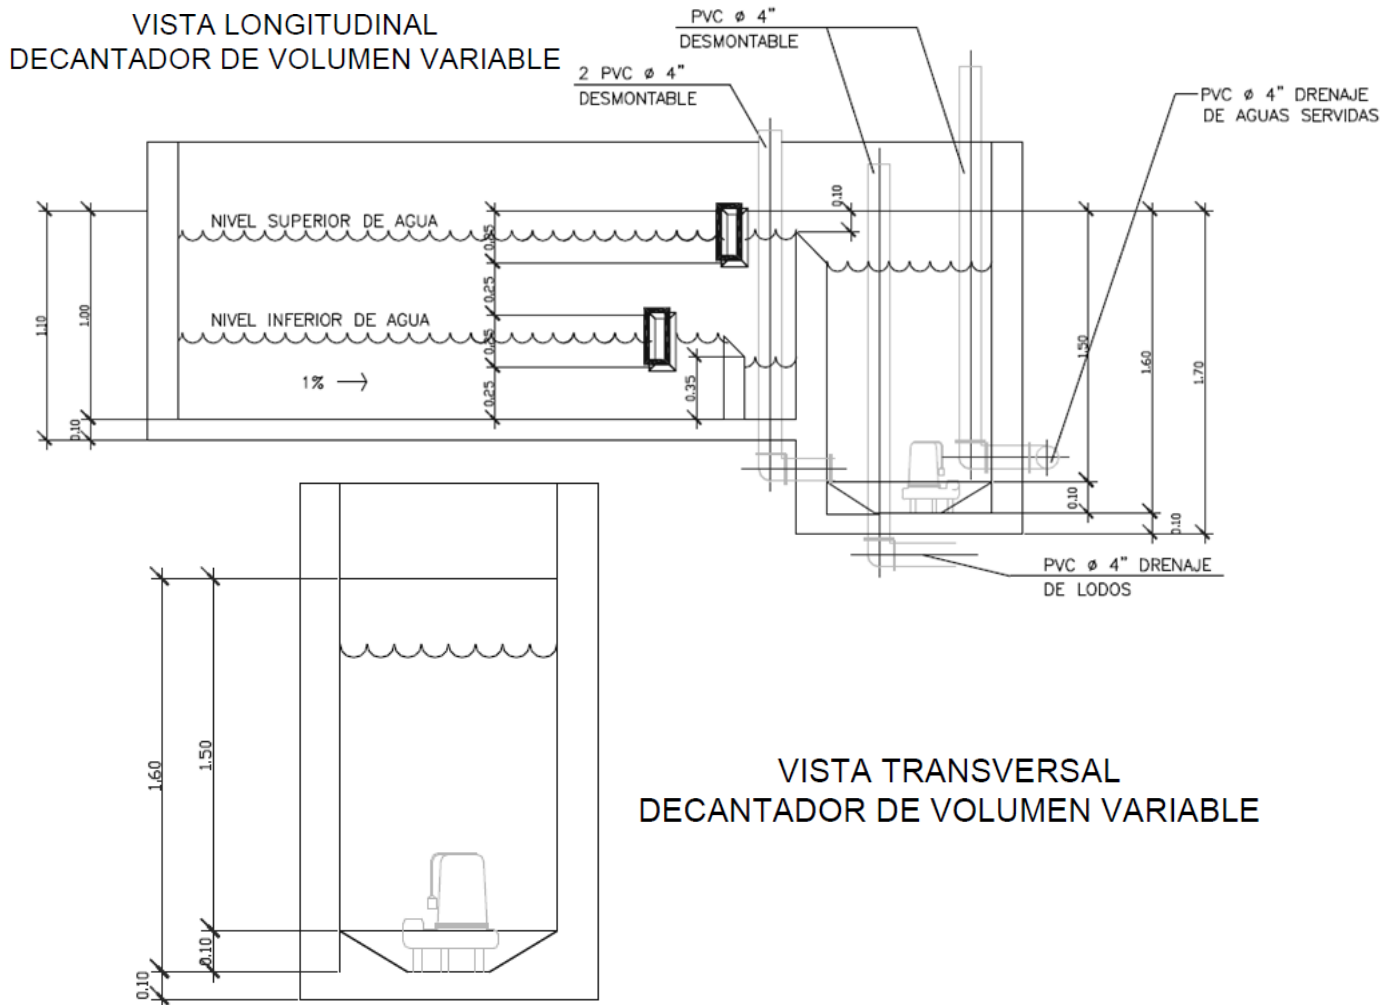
Detalles del decantador de volumen variable vista longitudinal y transversal.
